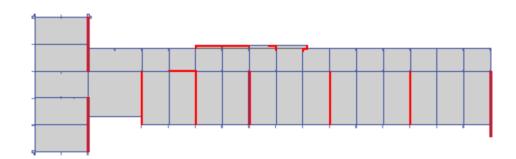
Planta primer piso, Escuela Unión Latinoamericana Edificio 2.
